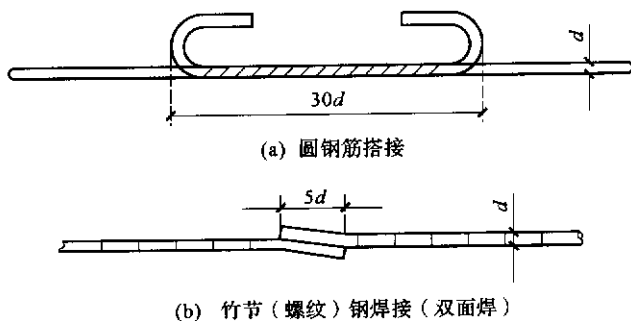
短段钢筋搭接焊接图
